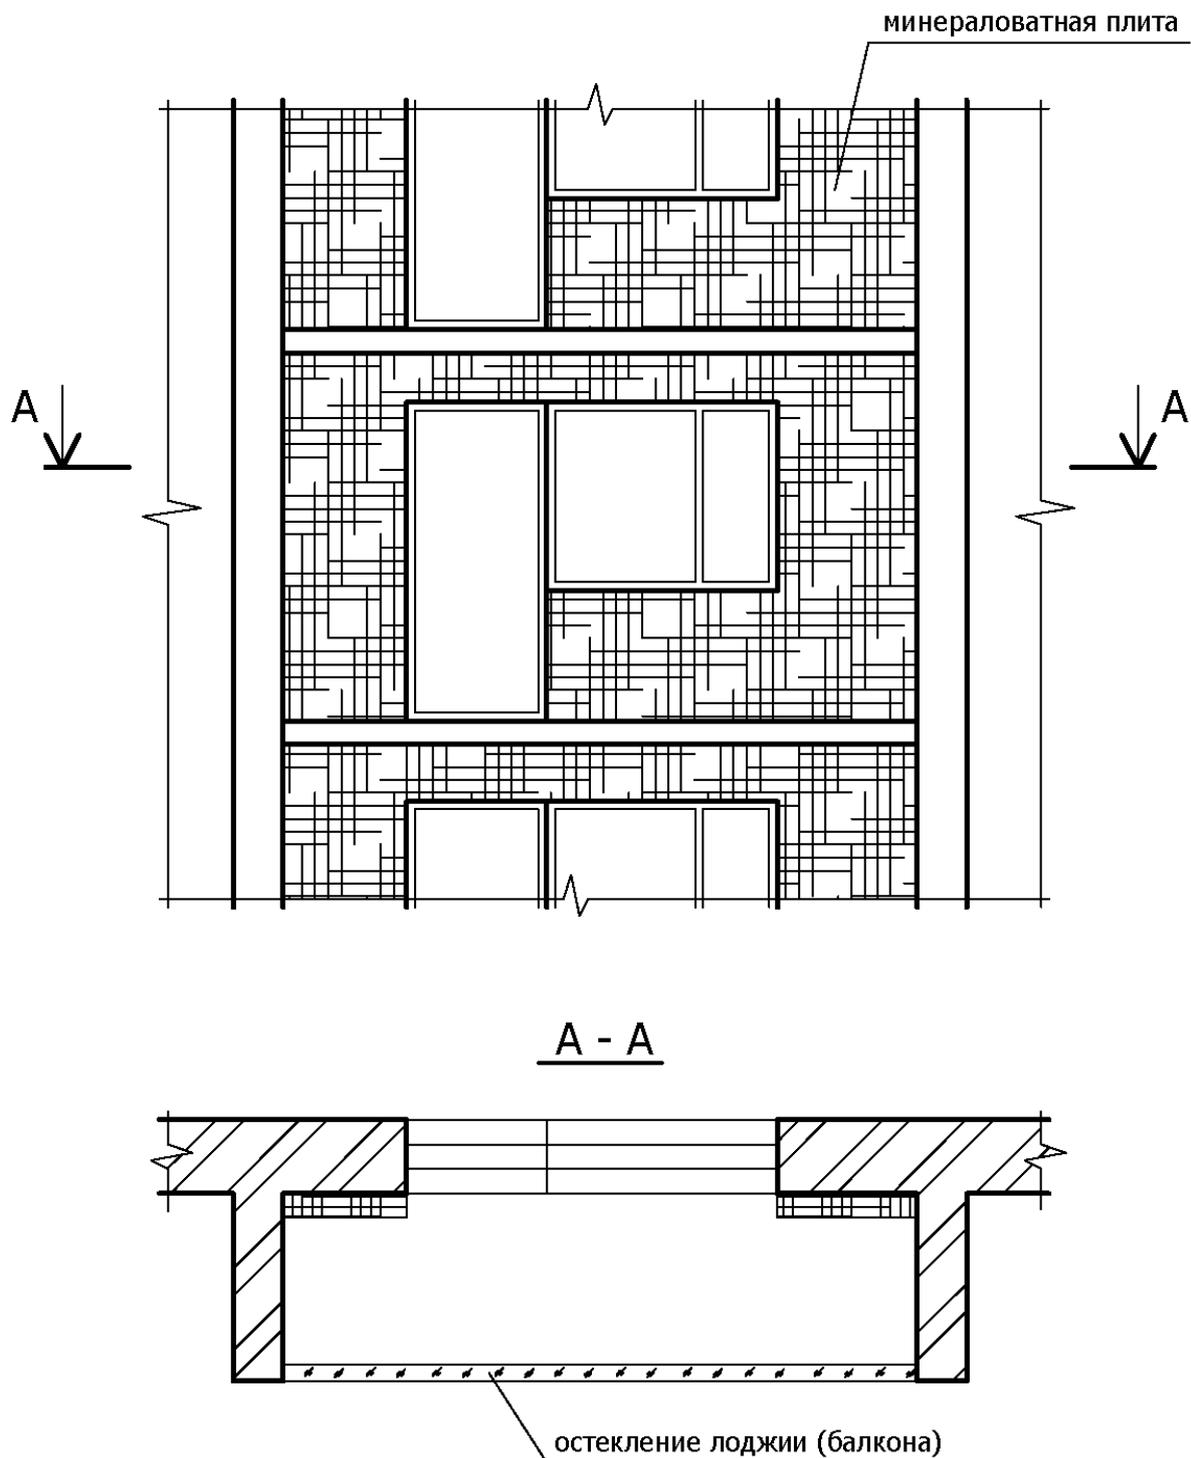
Утепление остекленных лоджий и воздушных переходов незадымляемых лестничных клеток. Утеплитель – минераловатная плита
